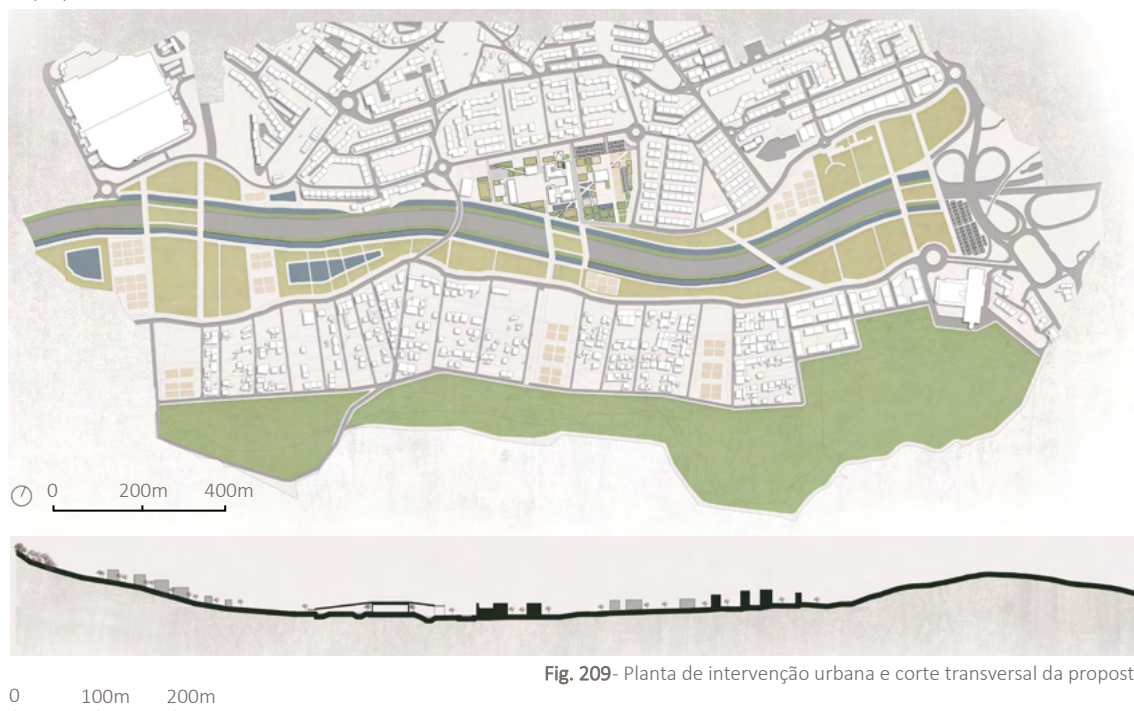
Planta de intervenção urbana e corte transversal da proposta
